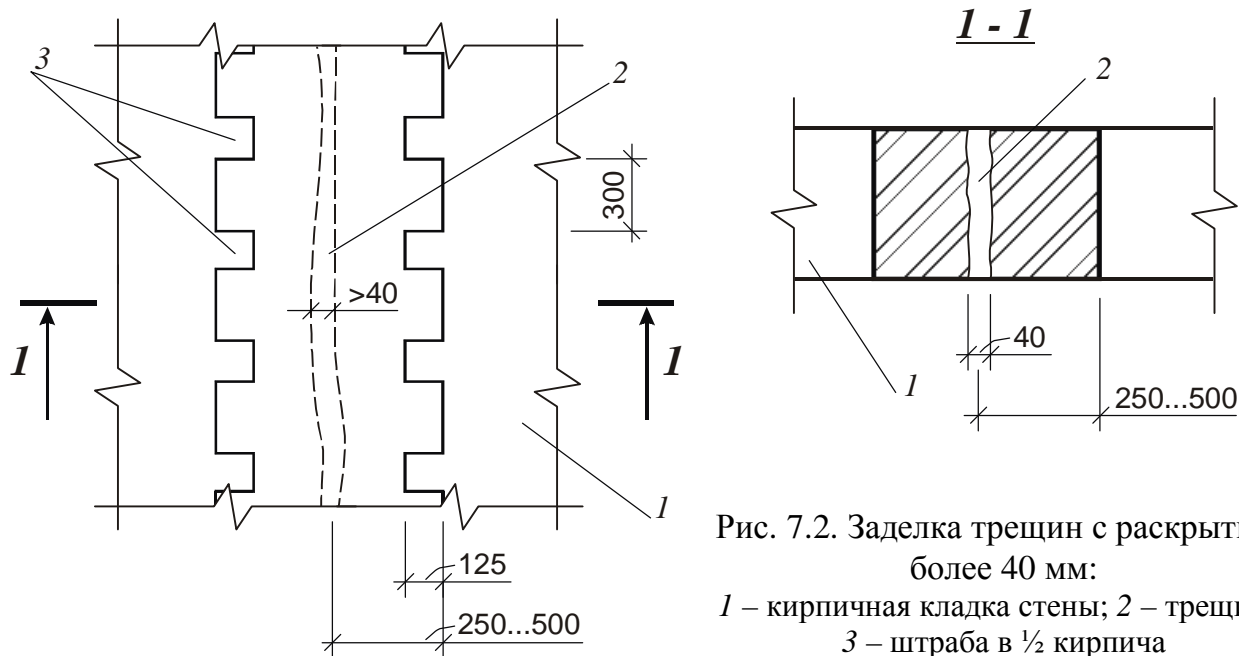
Заделка трещин с раскрытием более 40 мм:
